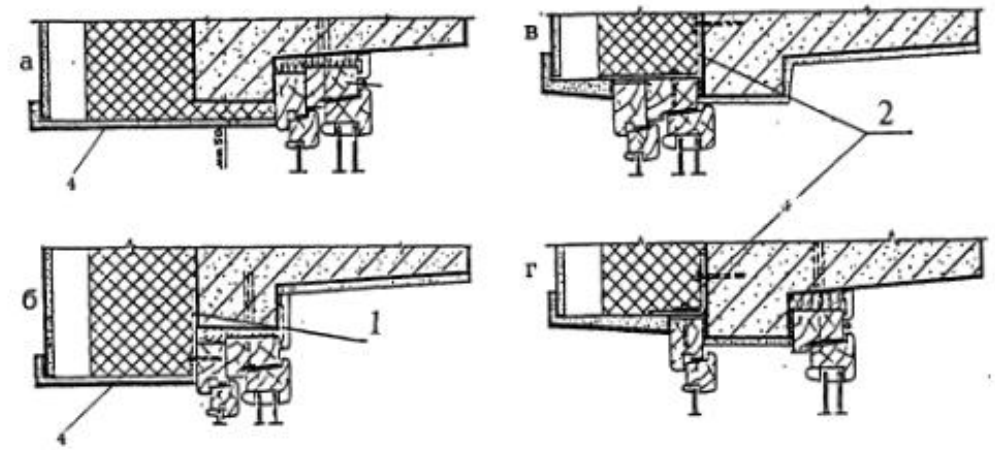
Варианты размещения новых конструкций окон при реконструкции: а - на прежнем месте, б - со сдвижкой наружу, но в габаритах первоначальной конструкции стены, в - в толще утепляющего слоя с наружной стороны стены, г - с отдельной установкой наружной и внутренней коробок: 1 - фиксирующая планка из нержавеющей стали, 2 - крепежный уголок из нержавеющей стали, 4 - наличник
